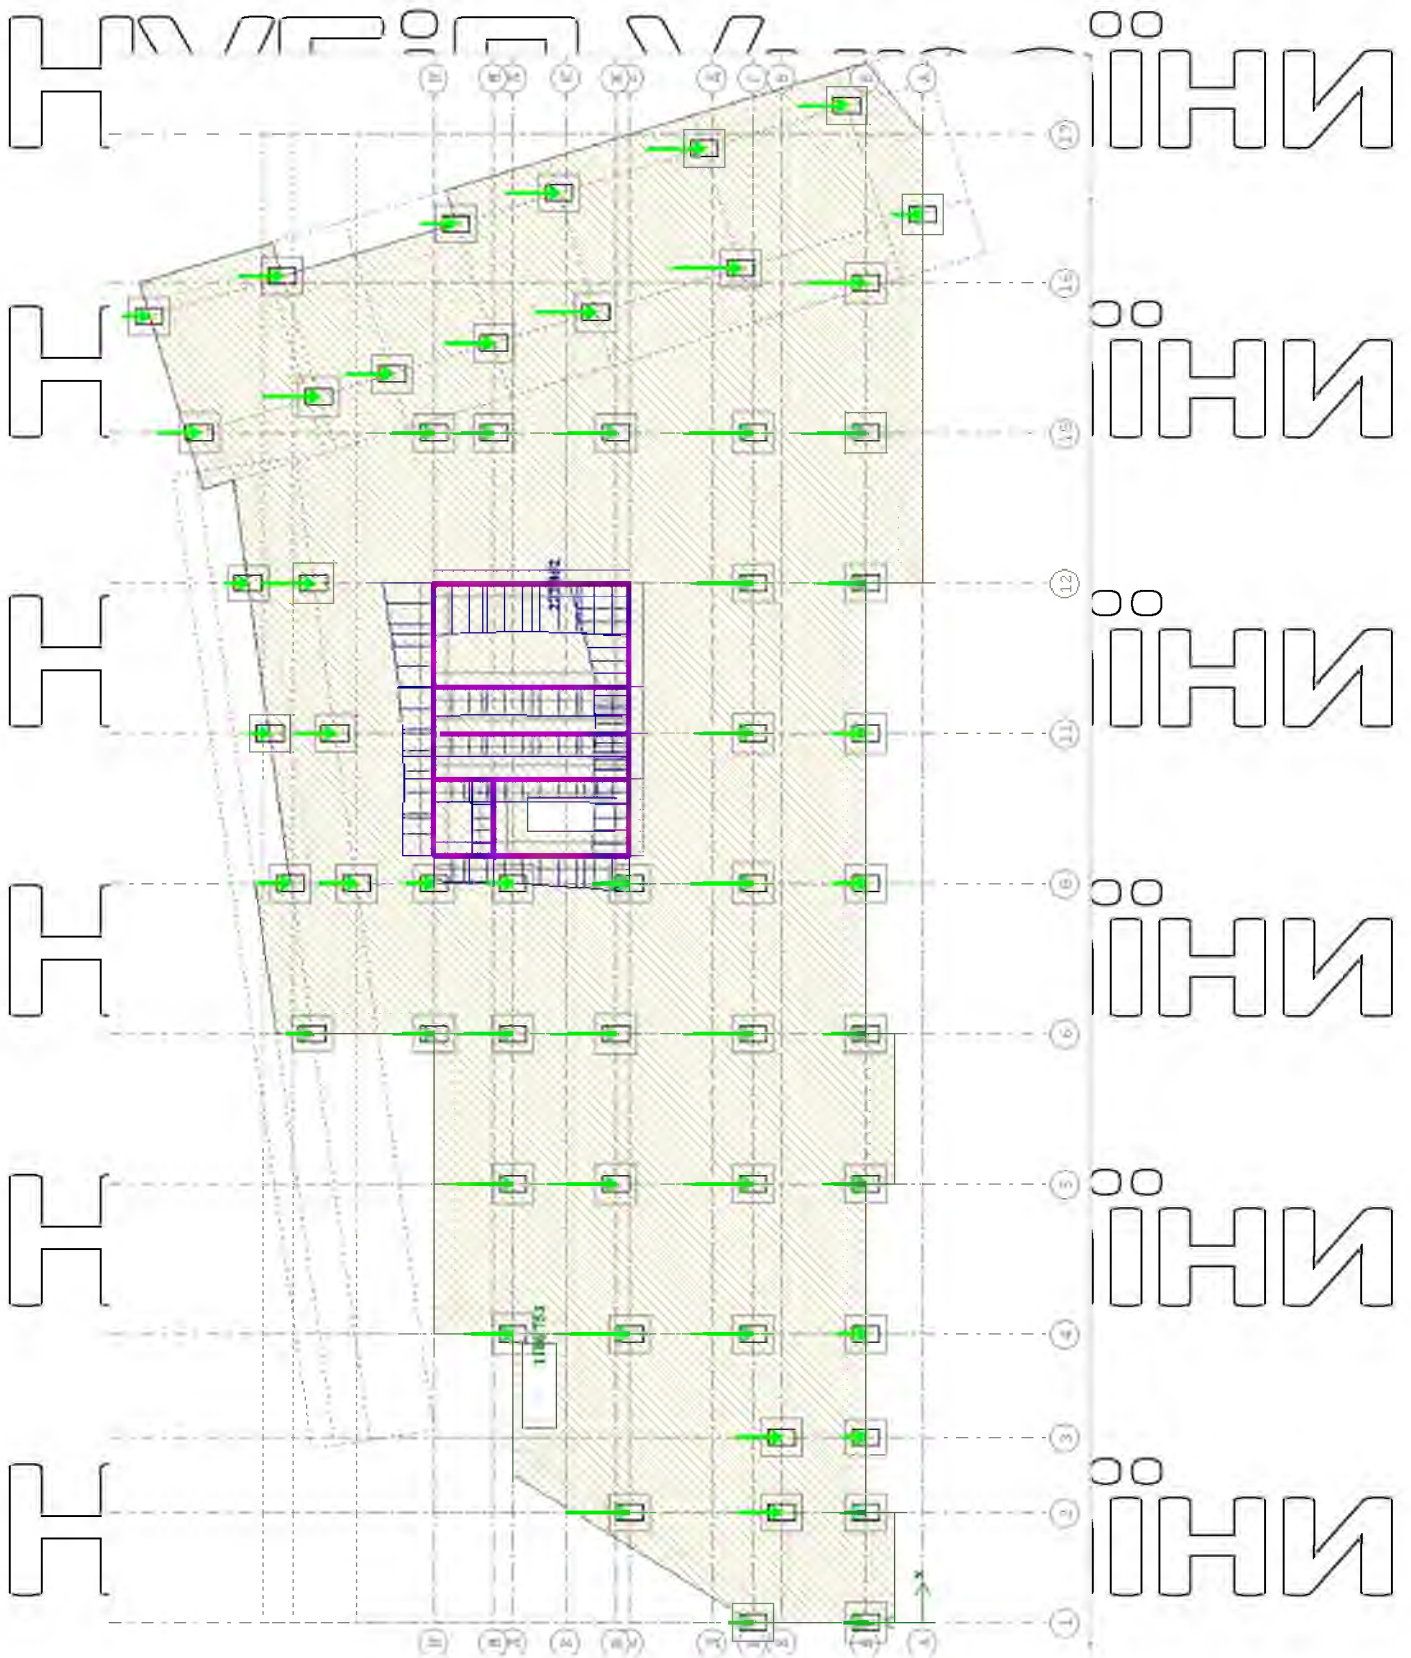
Розрахункова схема до визначення зусиль у фундаменту
